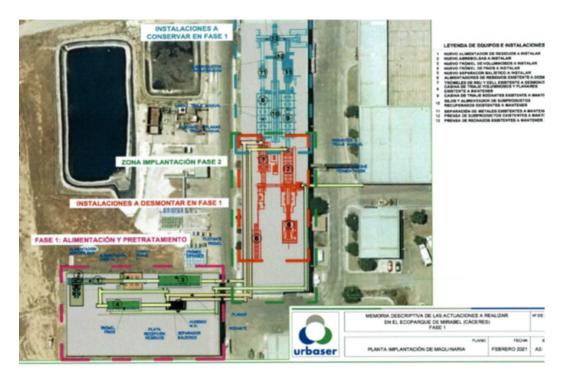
Plano 1 en planta de la instalación. Zona de tratamiento
